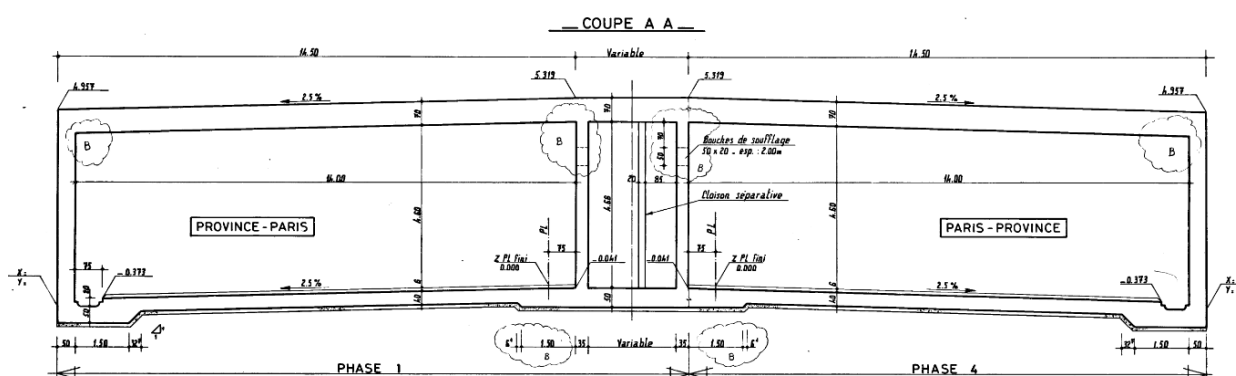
Profil en travers-type du tunnel de NEUILLY (section courante en double portique)
